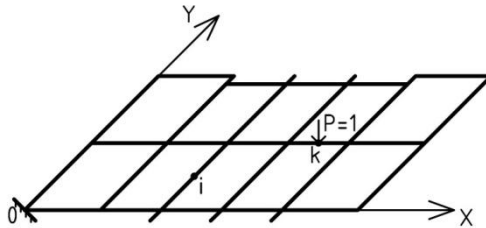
К расчёту системы перекрёстных балок смешанным методом
